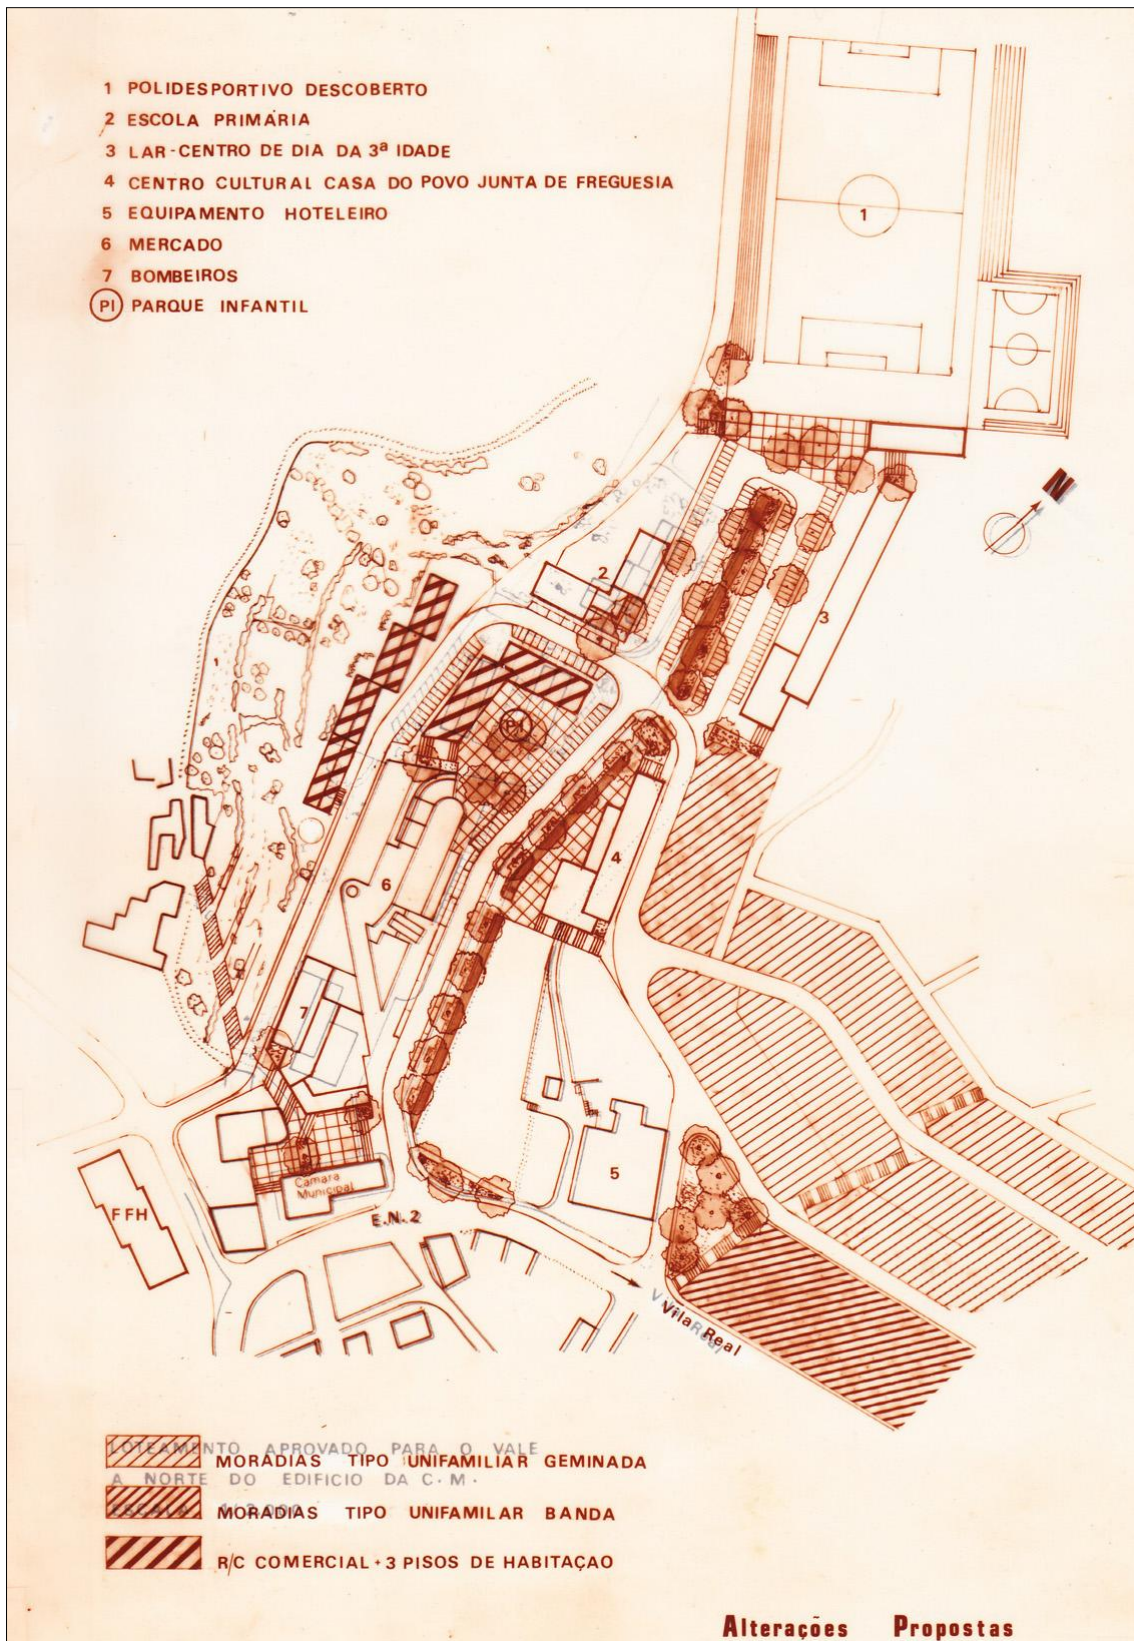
Planta do estudo para a área de expansão da Vila de Santa Marta (1981)
